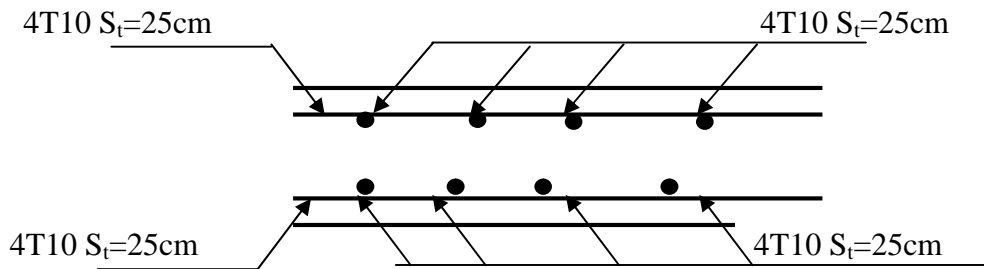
Vue en coupe du ferrailage de la dalle.
